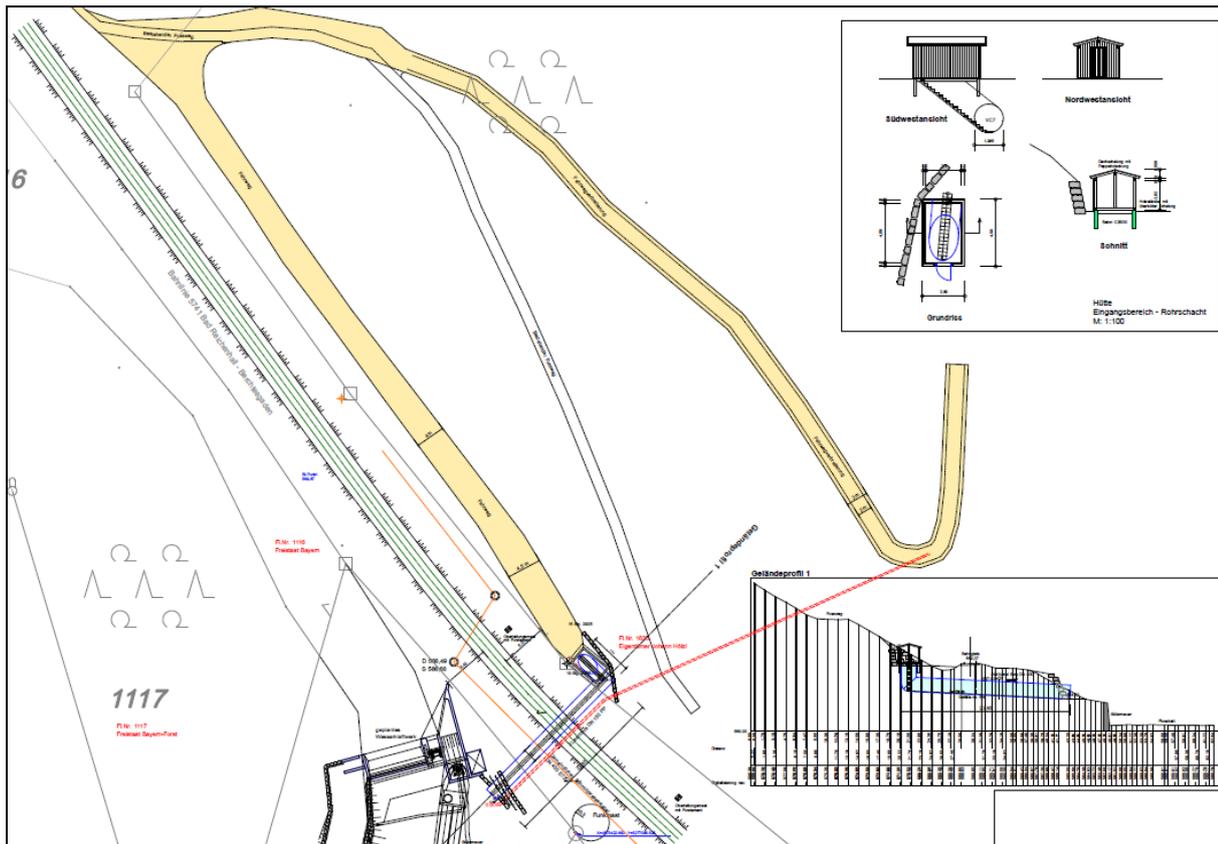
Lageplan mit Schnitten Zuwegung, Bahnrohrunterquerung und Holzgebäude oberer Zugang – Planung (IB Liebl 2014)
